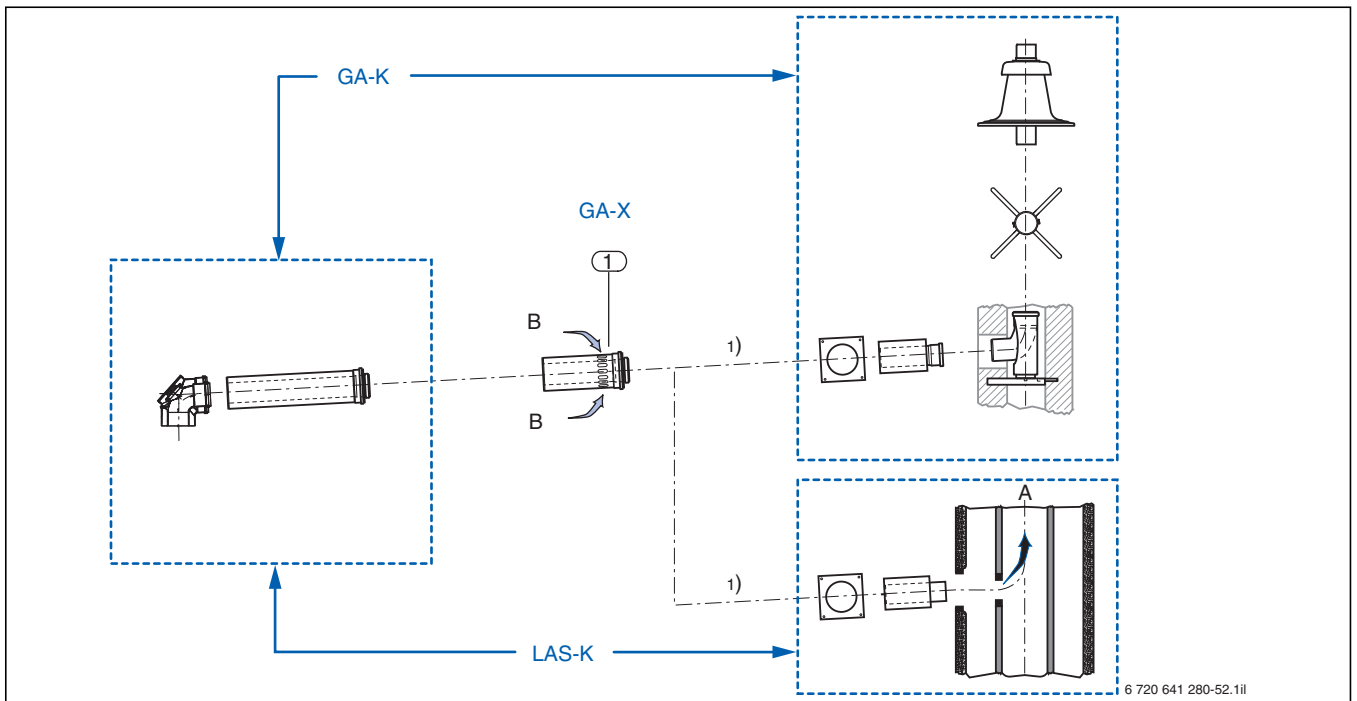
Bauteile des Grundbausatzes GA-X aus Kunststoff in Verbindung mit dem Grundbausatz GA-K (→ Tabelle 47, Seite 108) oder LAS-K (→ Tabelle 47, Seite 108)
